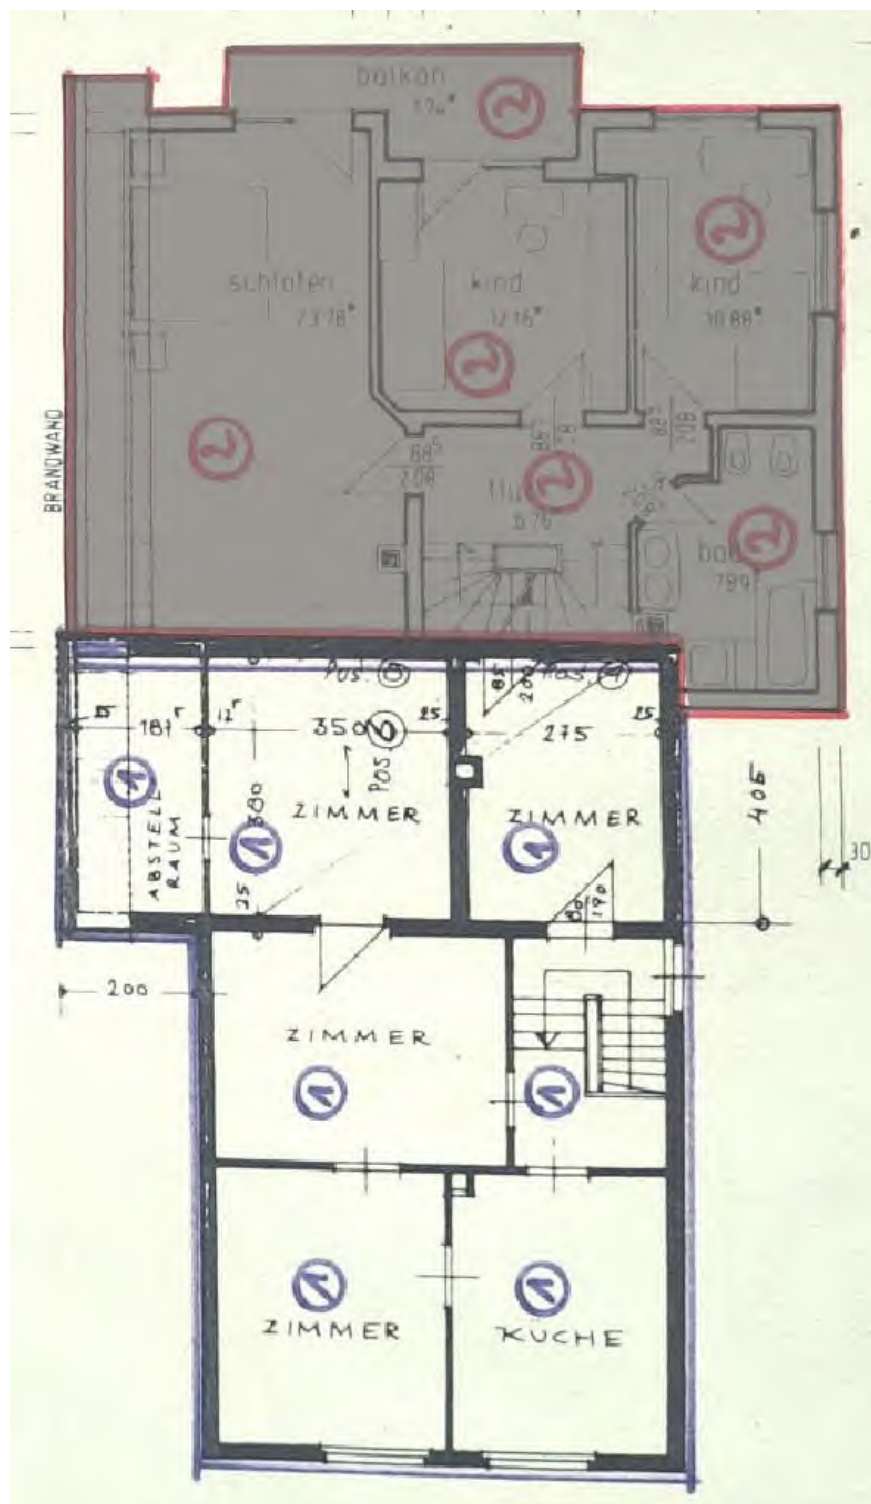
Grundriss Ober-/Dachgeschoss
